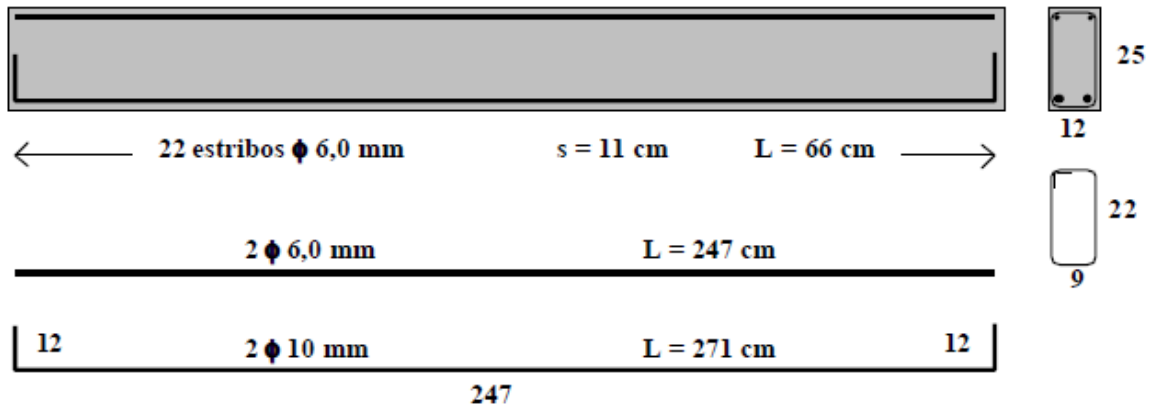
Detalhamento das vigas ensaiadas por Beber [1].
